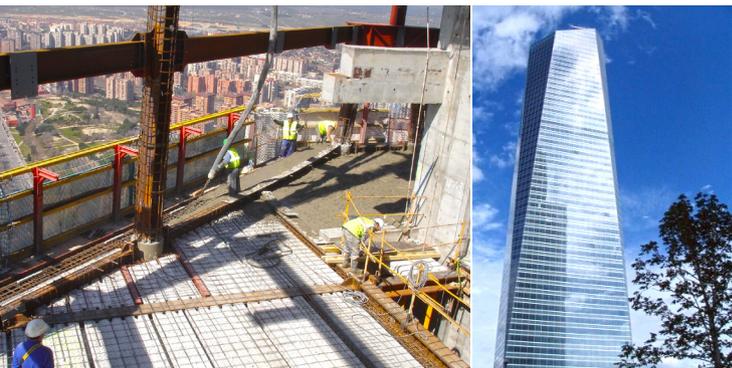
Execução do pavimento com lajes alveolares de concreto protendido (a) e imagem do edifício Torre de Cristal (b).
